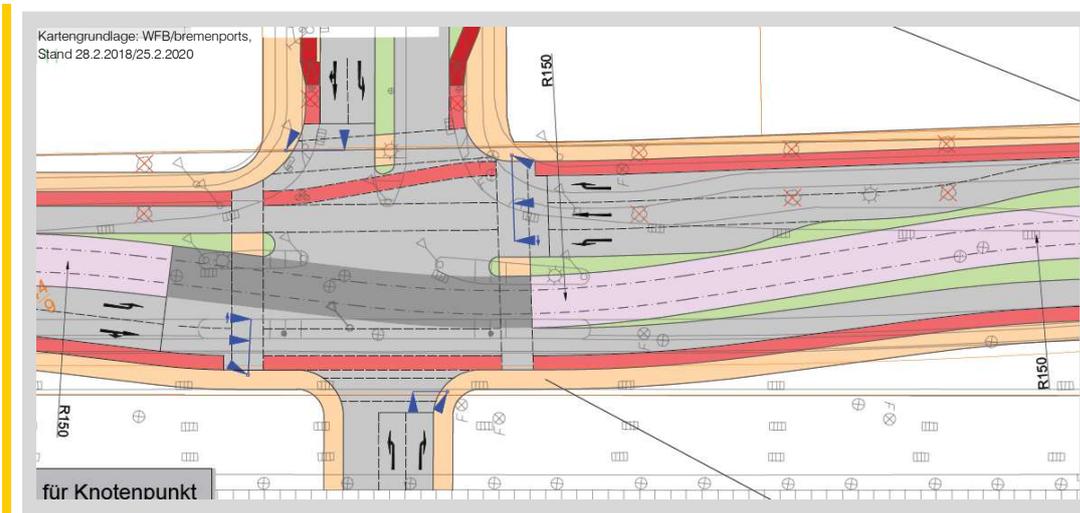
Ausschnitt Lageplan Knoten Konsul-Smidt-Straße/ Überseetor
